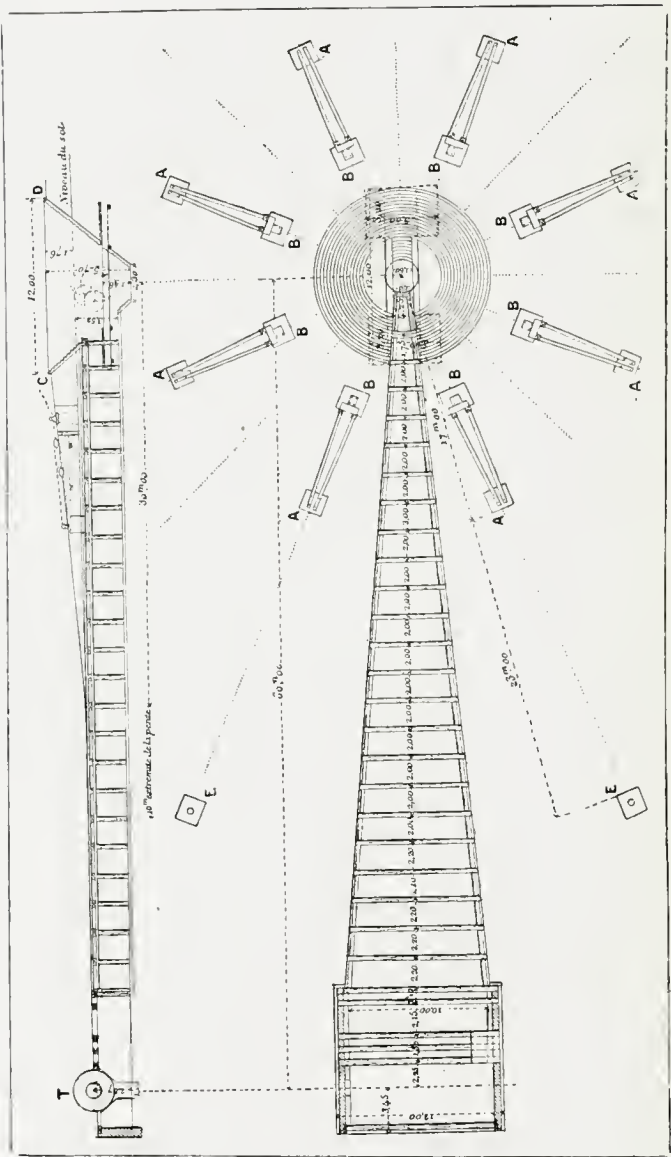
Tunnel souterrain du câble (coupe et plan).
